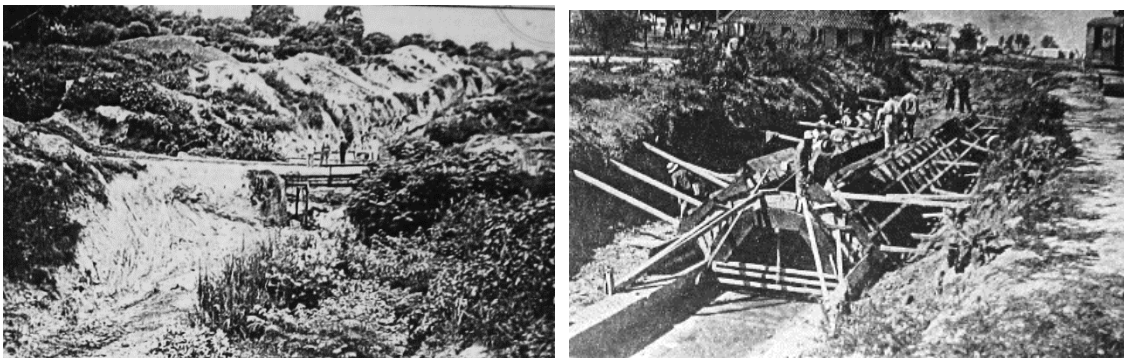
(izq) Izq. Excavación previa al entubamiento del arroyo Poncho Verde, propiamente dicho. Vista del puente “Liberal” 10 de enero de 1958. Der. Arroyo Poncho Verde en otro sector. Fuente: Minadeo 1988.
